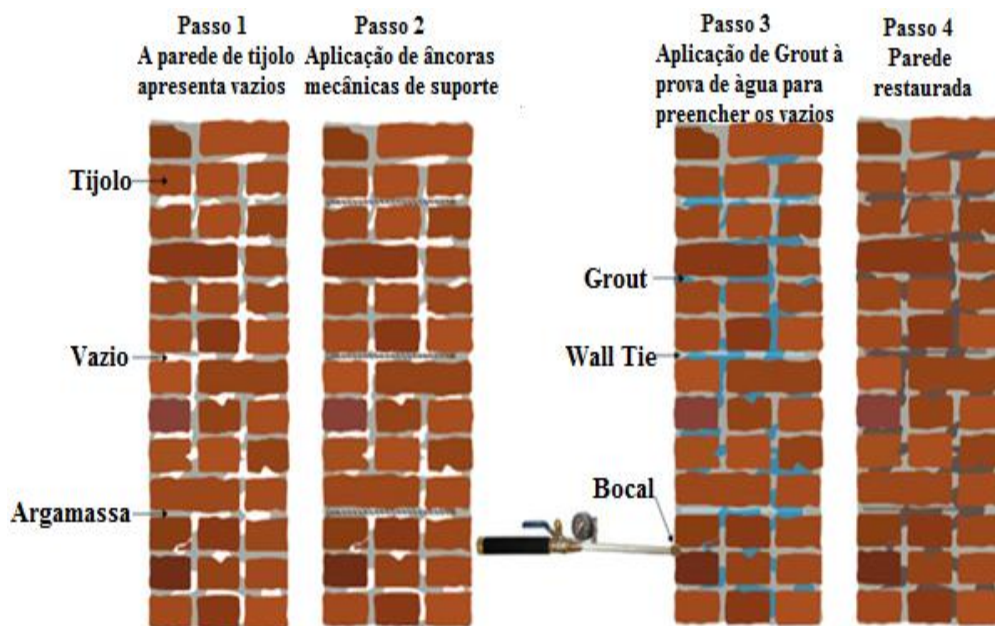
Exemplo de injeção, (adaptado de masonry grout injection, 2016)
